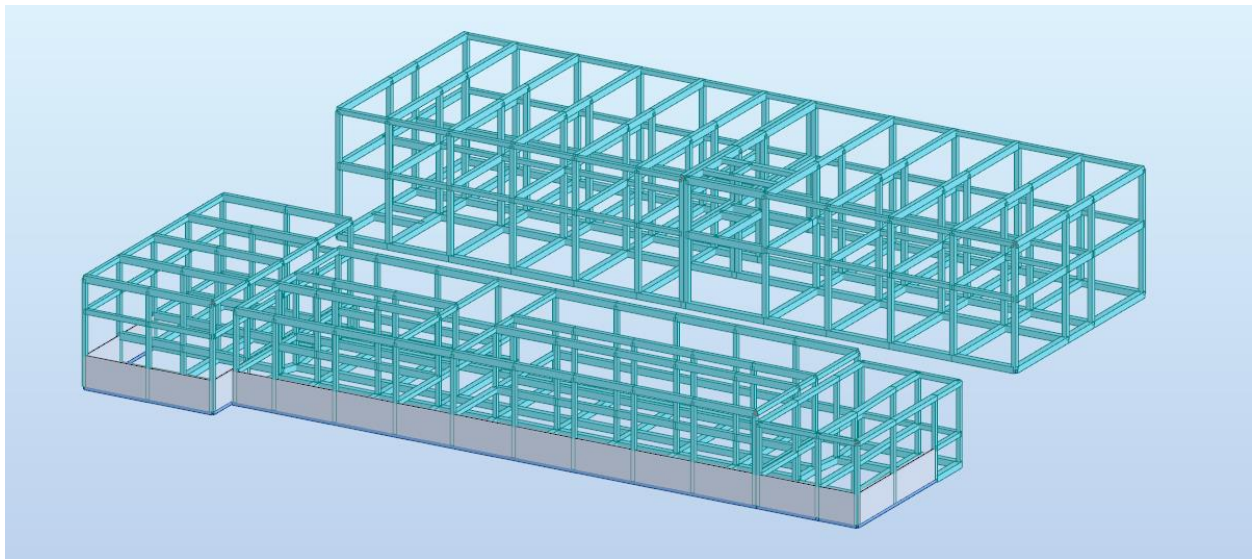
Vista 3D en Robot con las secciones visibles
